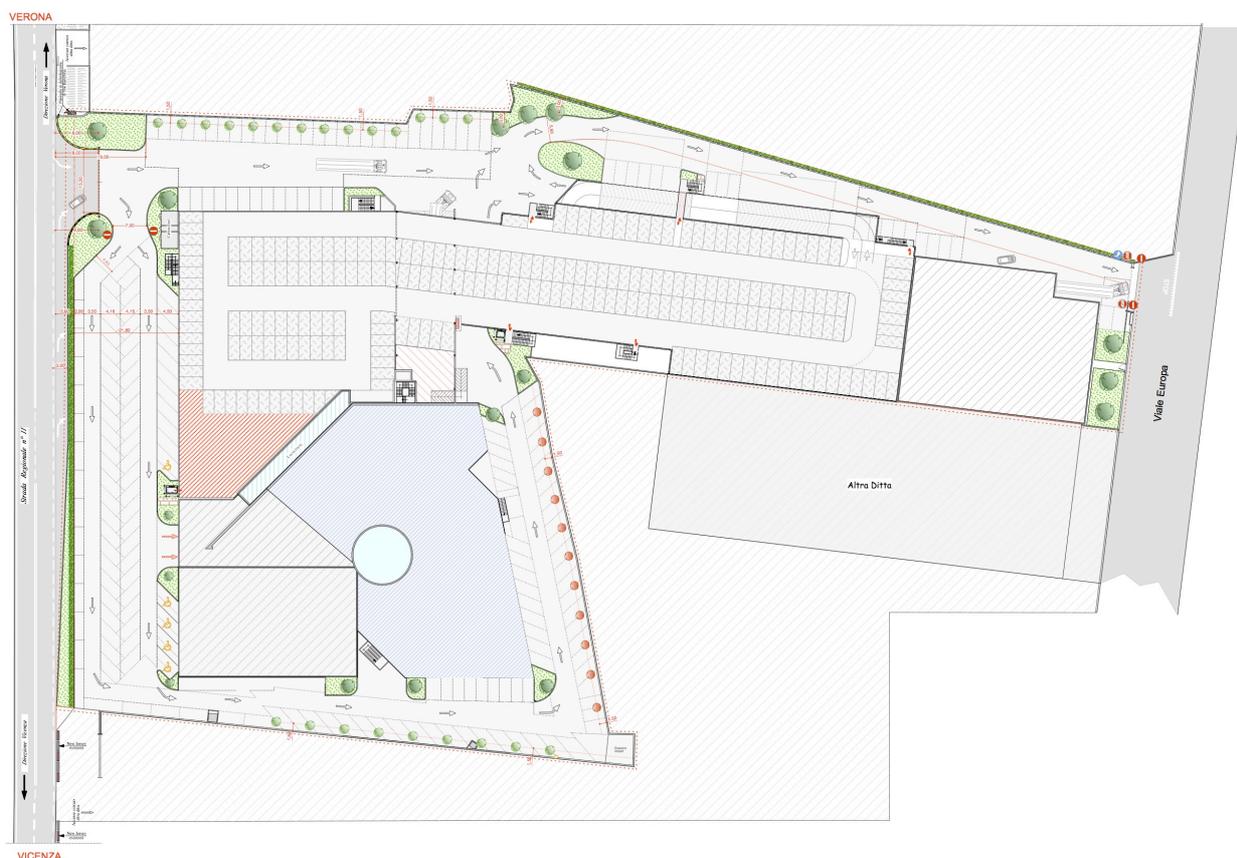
Planimetria generale-accesso/egresso e organizzazione dei parcheggi
